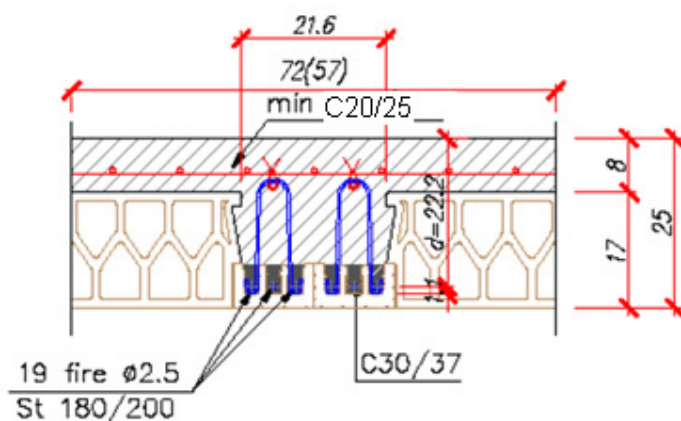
Detaliu sectiune planseu cu structura dubla de grinzi si suprabetonare 8cm
